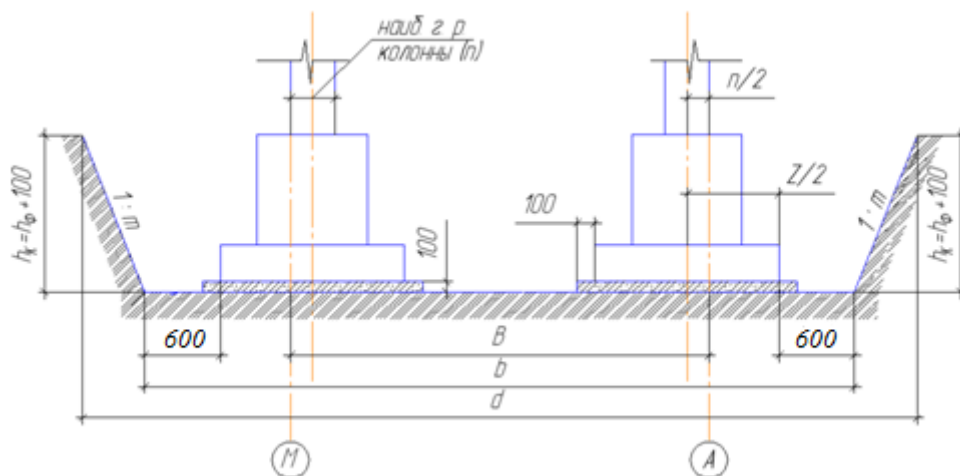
Поперечный разрез котлована с установленными столбчатыми фундаментами.
